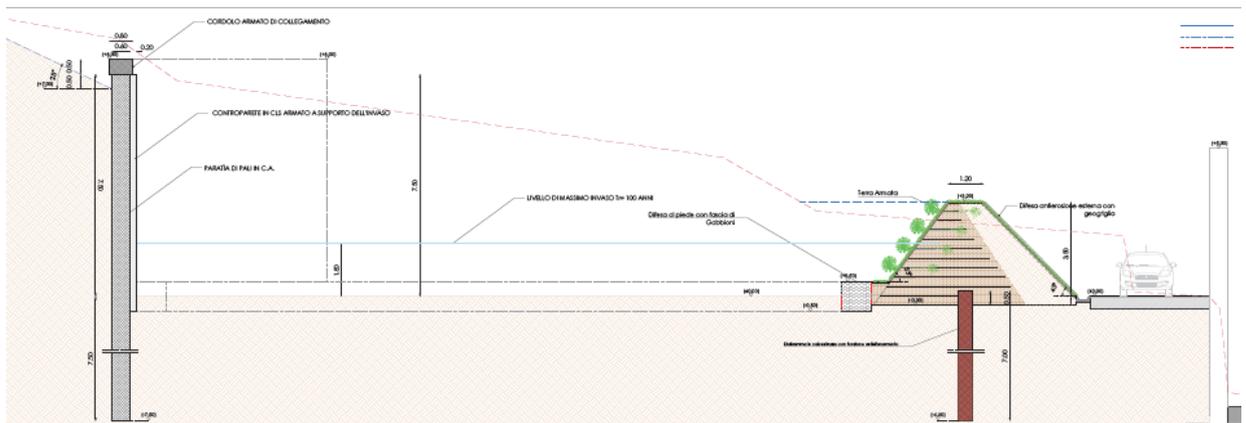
Sezione Bacino di Laminazione con Terra Armata e Cortina di Pali
